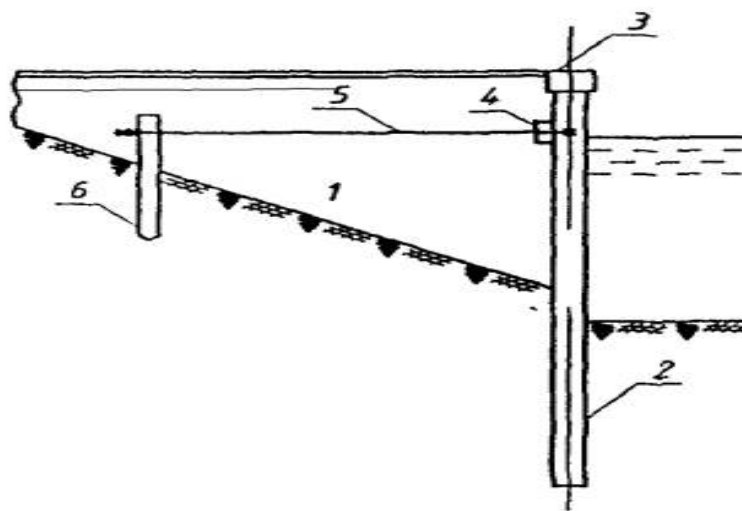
Шпунтова стінка з шпунта «Ларсен» з анкерним кріпленням
